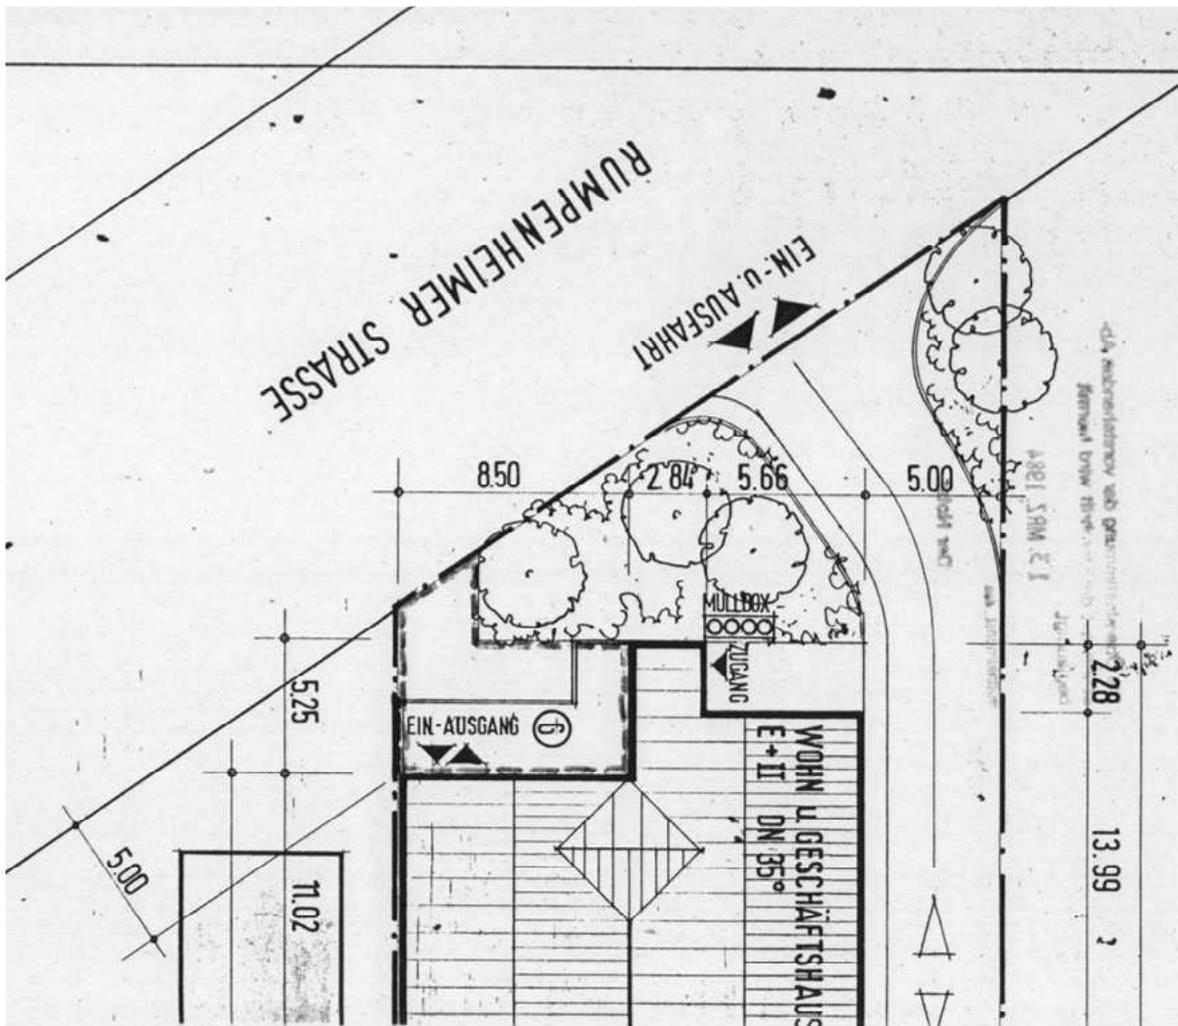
Freiflächenplan Sondernutzungsrechte vorderer straßenseitiger Bereich, „Ein-Ausgang“ (nicht maßstabsgetreu, aus Lageplan der Teilungserklärung)
